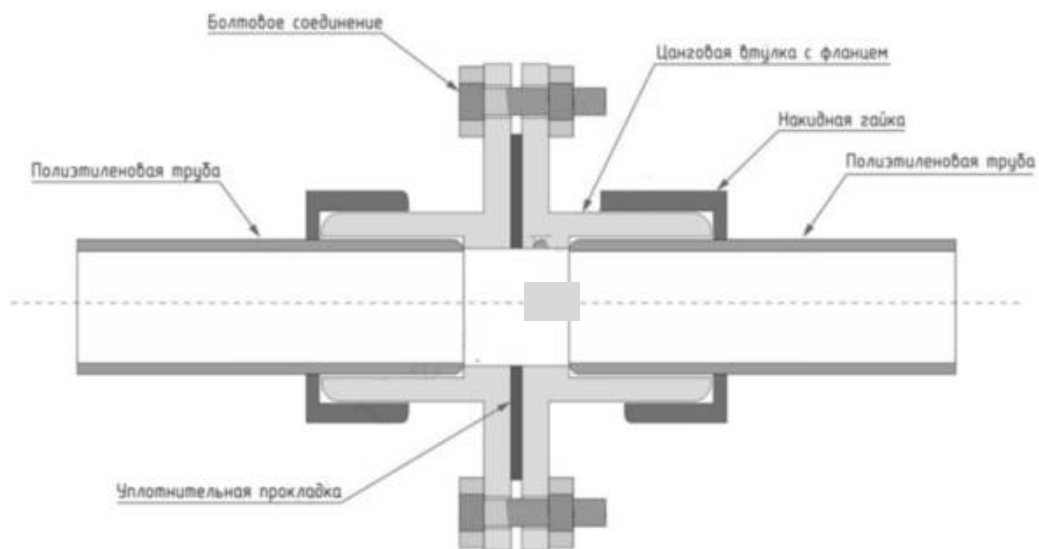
Схема фланцевого соединения пластиковых труб
